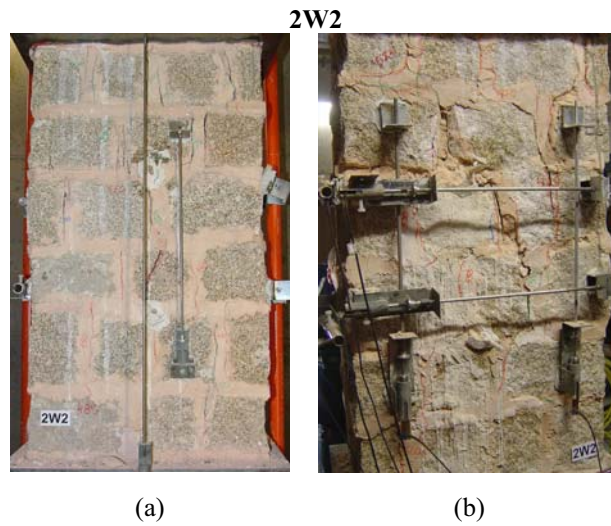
Padrão de fendilhação da parede 2W2 no final do ensaio: (a) face B; (b) face D.
